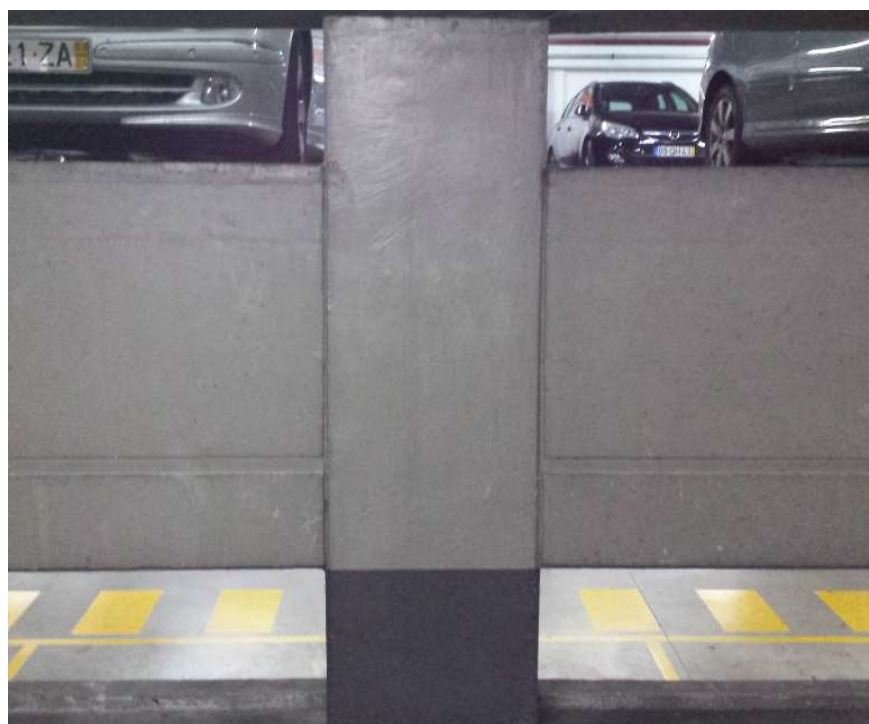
Pré-lajes pré-fabricadas (Alberran, 2008)
